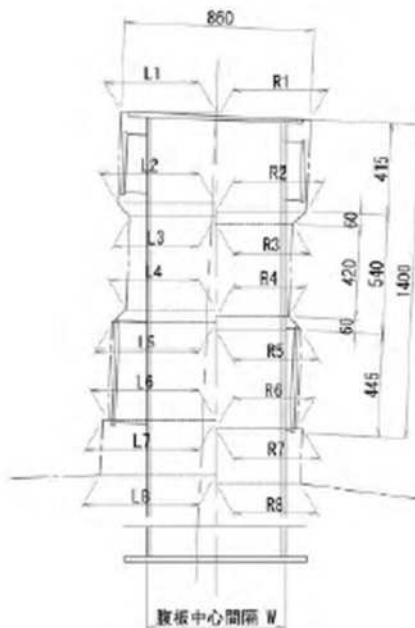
腹板中心線と軌道中心線を一致させた場合
